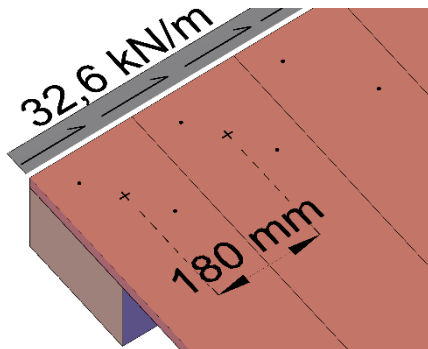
Possível esquema de distribuição de ligações entre o soalho e as vigas de bordo
